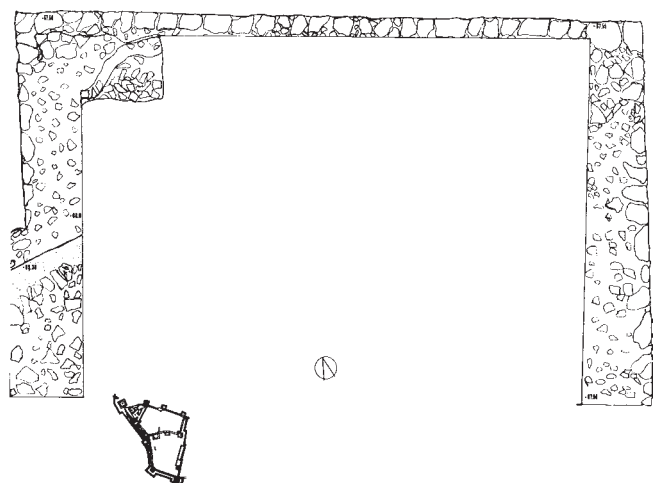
Torre 8. Planta de excavación de su cimiento.
